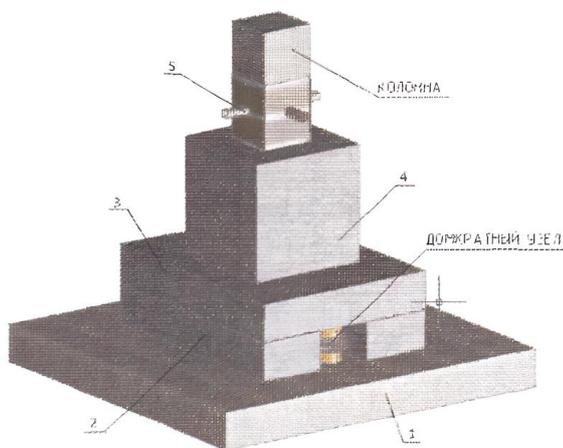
Регулируемый фундамент для проектируемых зданий с железобетонным каркасом: 1 – плитная часть фундамента; 2 – фигурная железобетонная плита; 3 – железобетонная плита; 4 – стаканная часть фундамента
